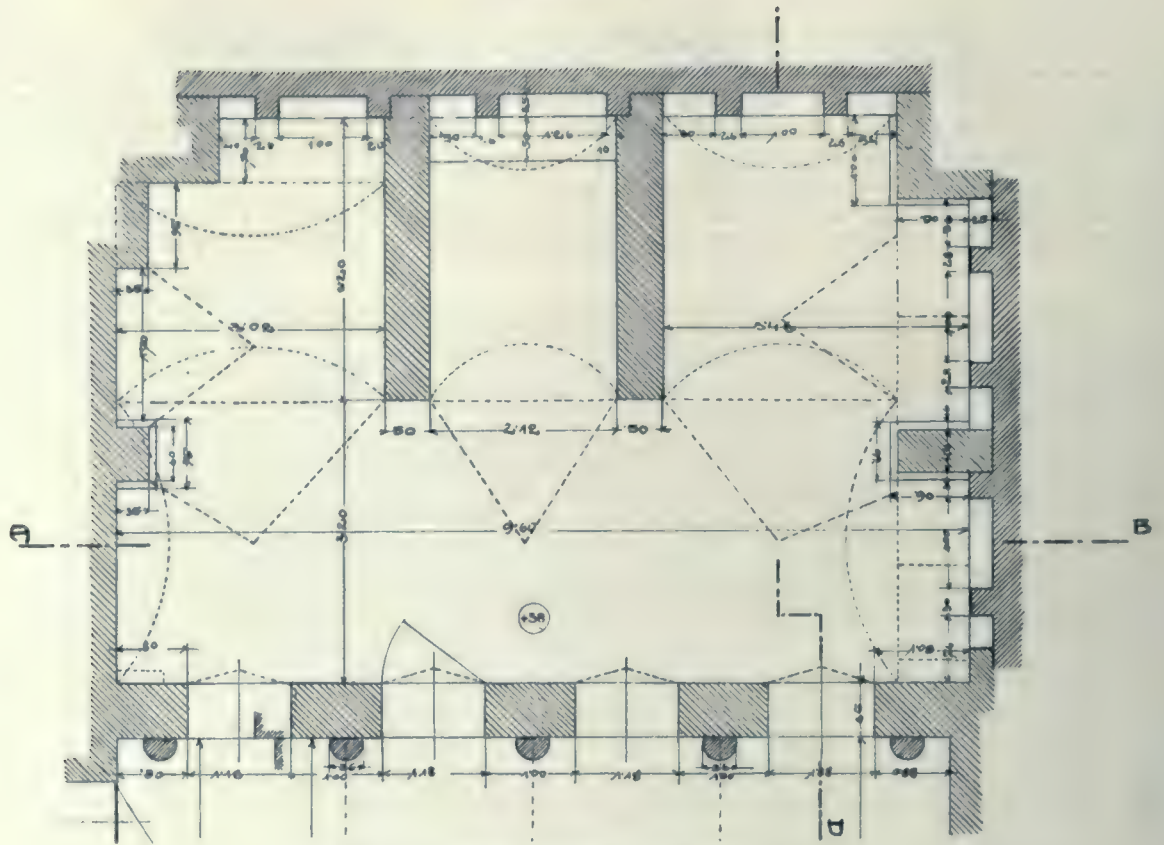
· Vorhalle (Paradies), Grundriß (S. 17)
